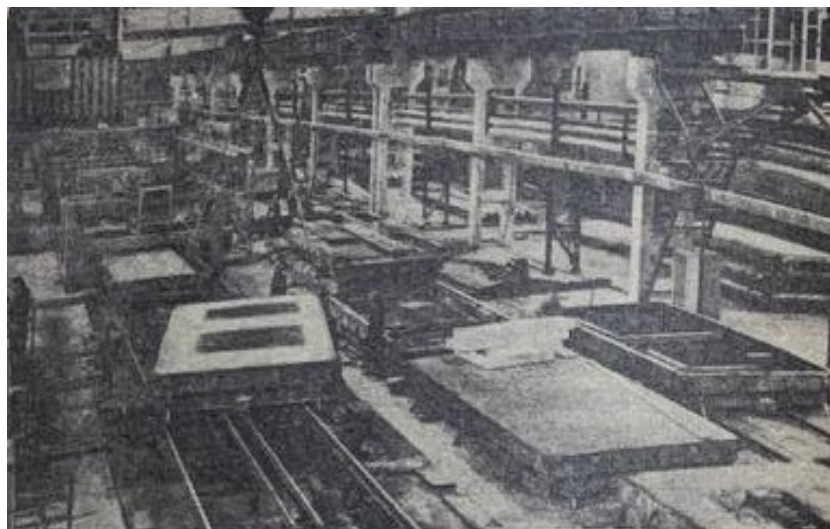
Конвейерная линия по изготовлению стеновых панелей из шунгизитобетона на комбинате строительных конструкций №1, г. Петрозаводск [3]
